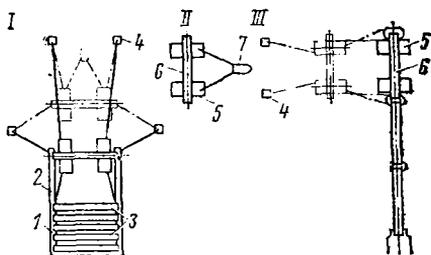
Стадии (I—III) перевозки пролетных строений на плавучих опорах:
